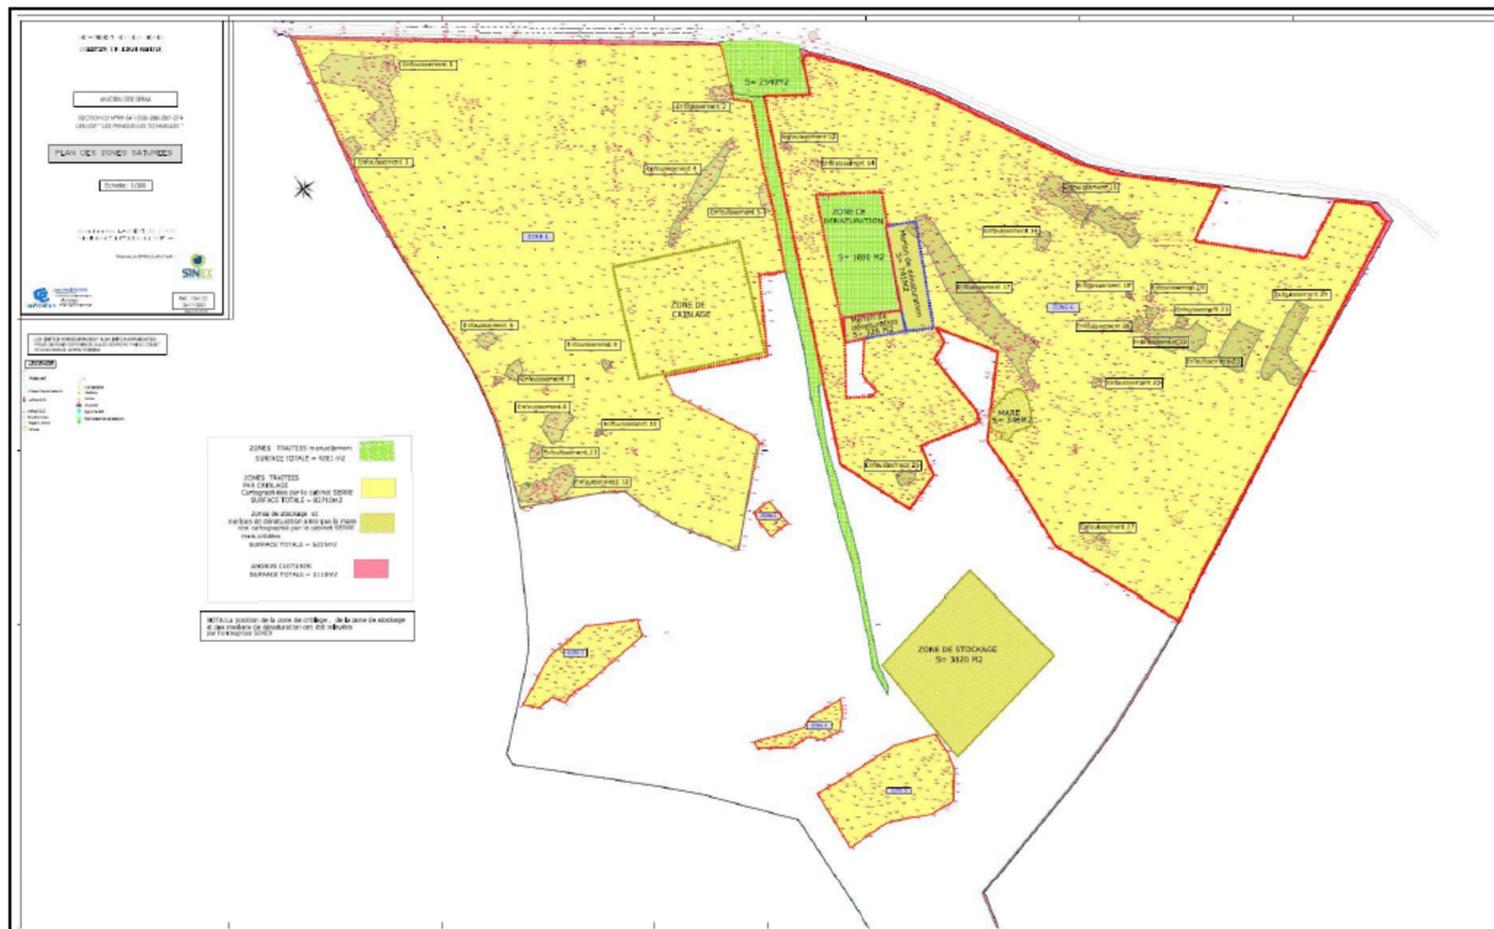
Plan des zones saturées traitées par criblage (Source SINEX)
